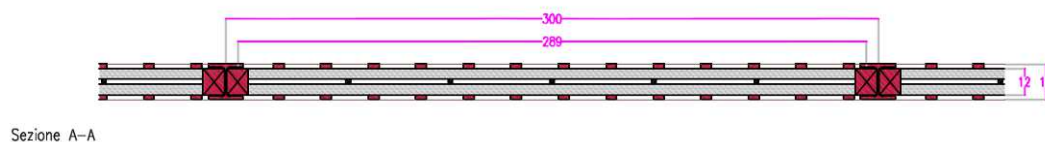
SEZIONE ORIZZONTALE DELLA BARRIERA ACUSTICA IN LEGNOI
